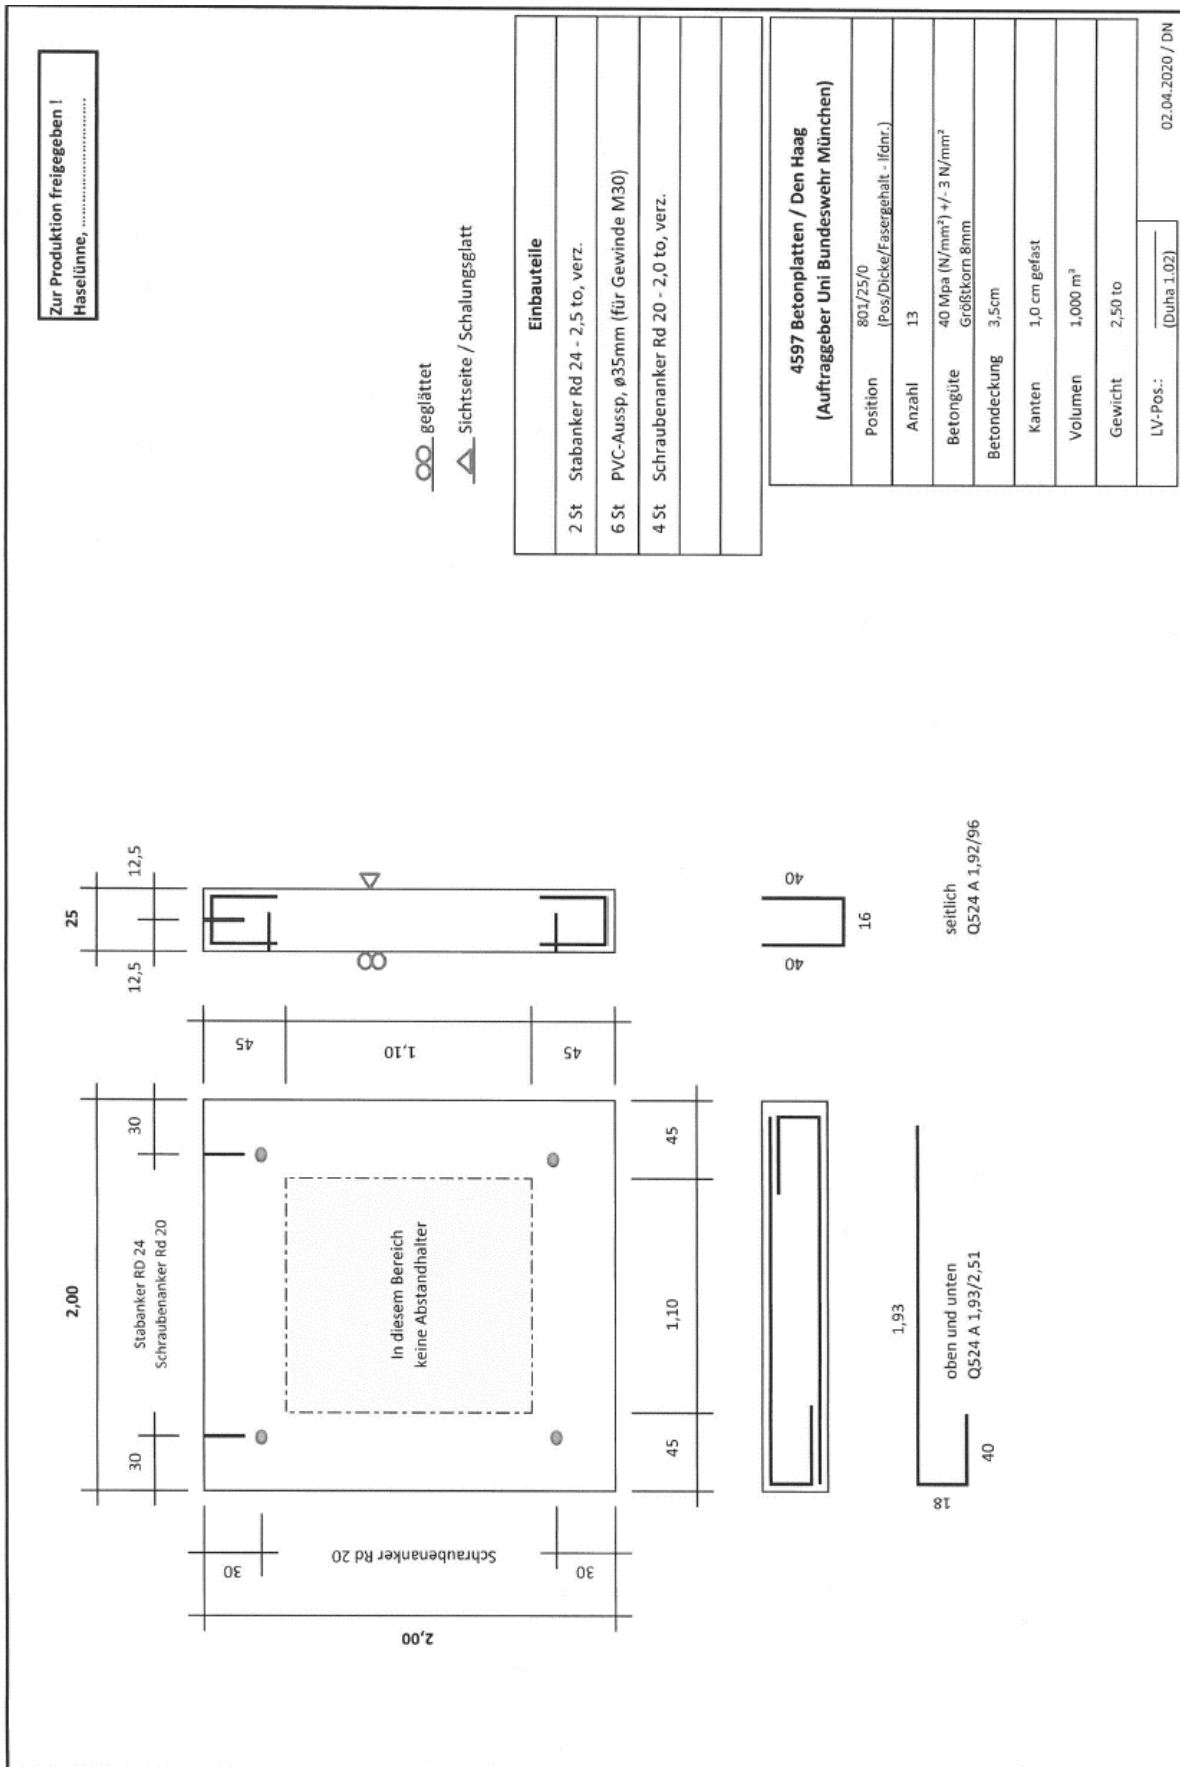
Bewehrungsplan für Stahlbetonplatten (d = 25 cm).
